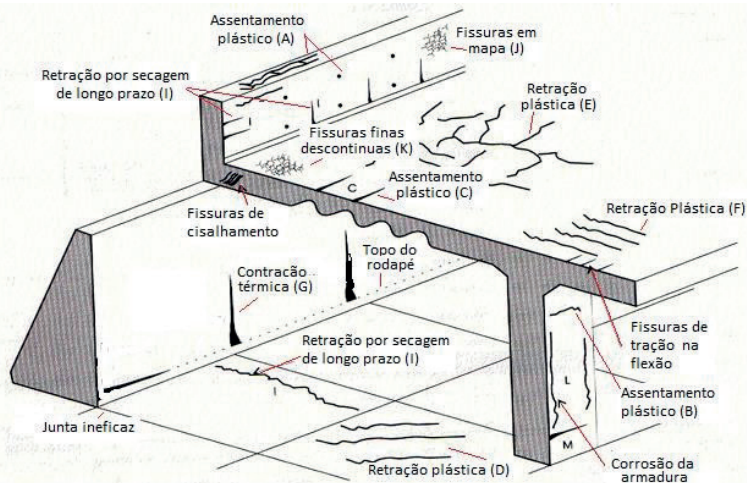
Tipos de fissuras nas estruturas de concretos. (Granato, 2014).
